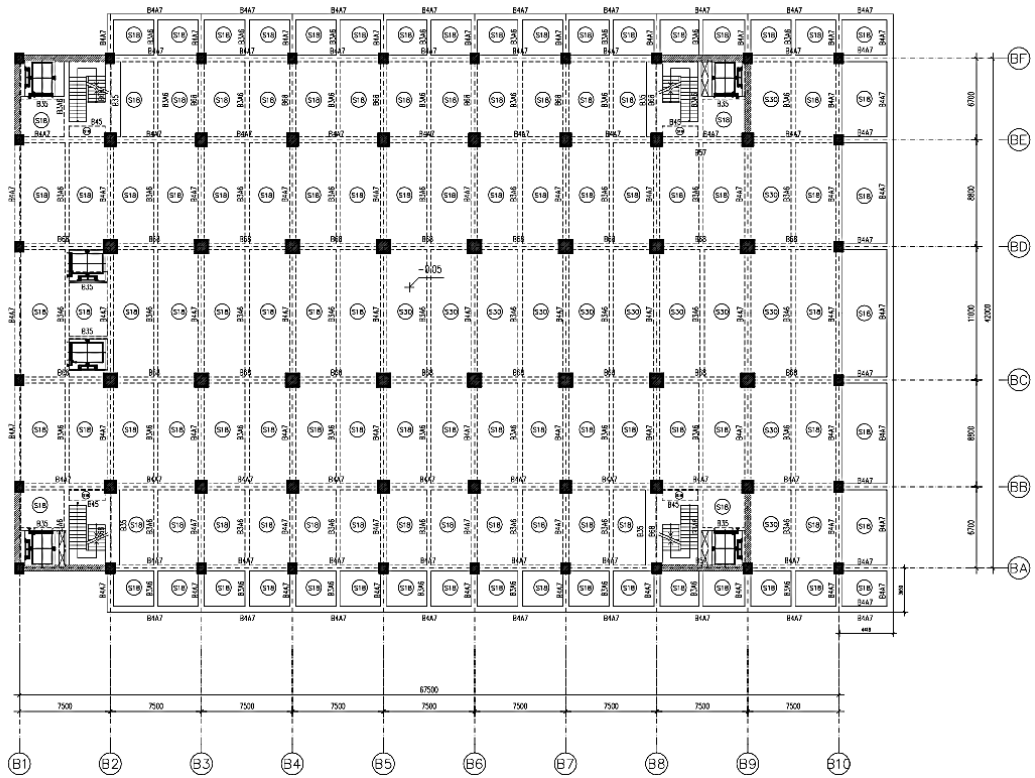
Denah pembalokan Lantai 2 Gedung Pelayanan
